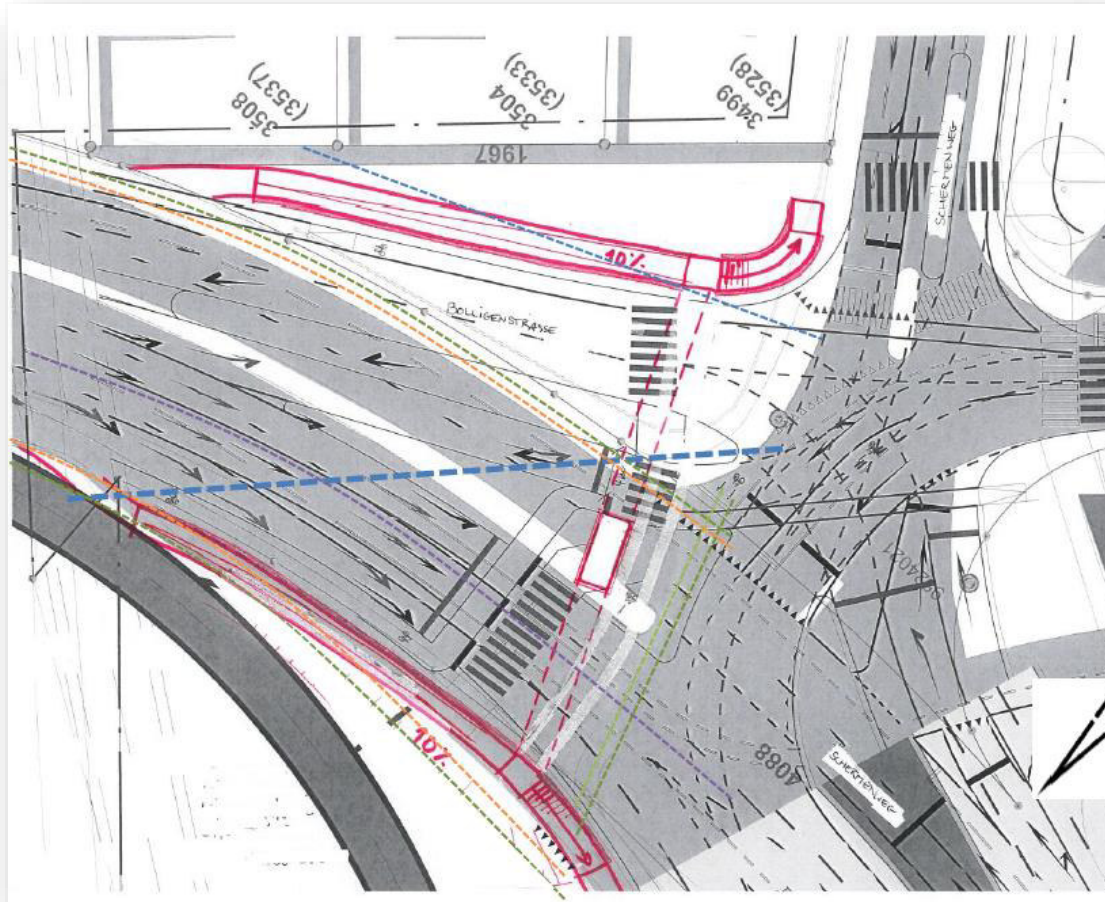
Grundriss Variante 2 "Personenüberführung"
